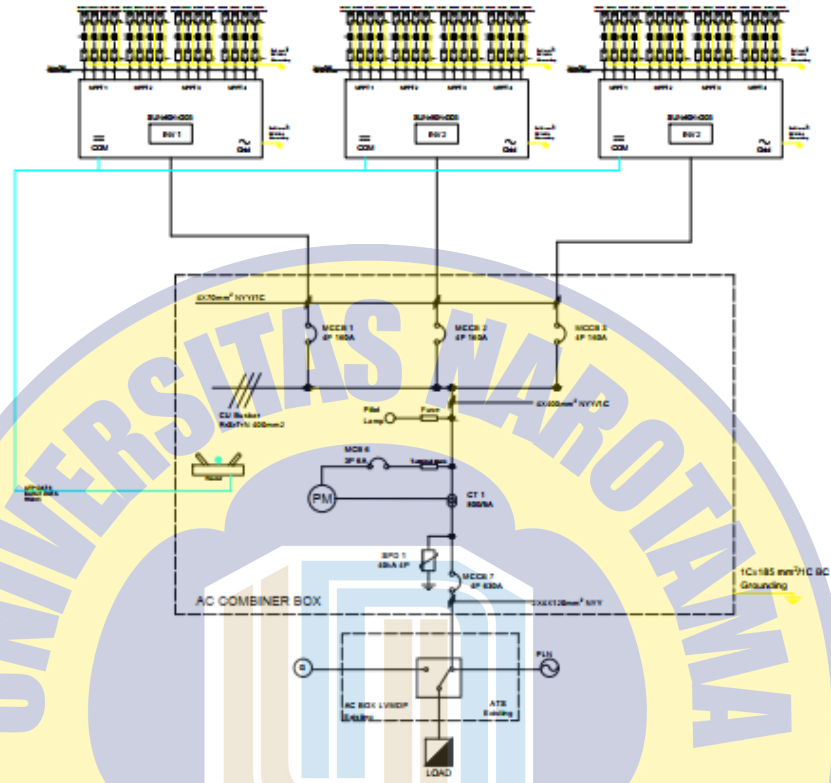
PV Layout PLTS Rooftop Gedung Pasar Gede Klaten
